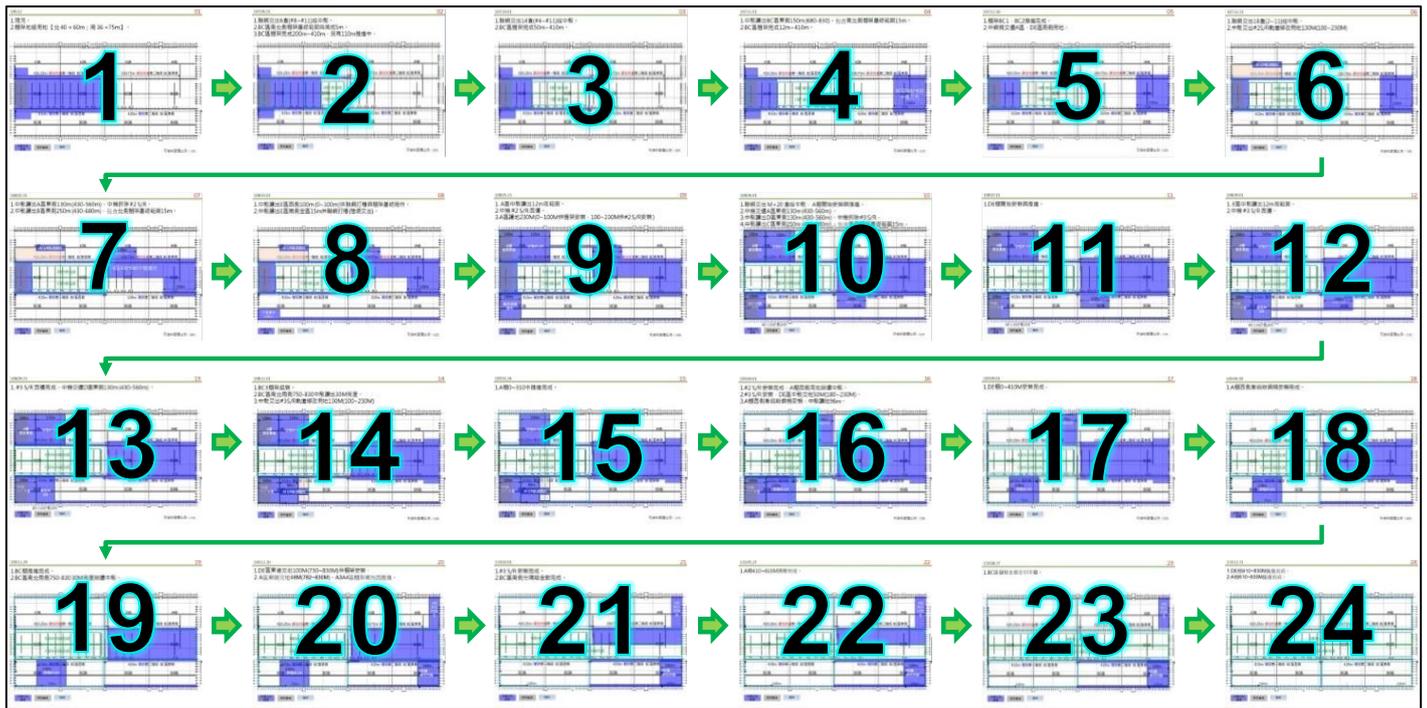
室內化棚架工程-施工步驟示意圖
